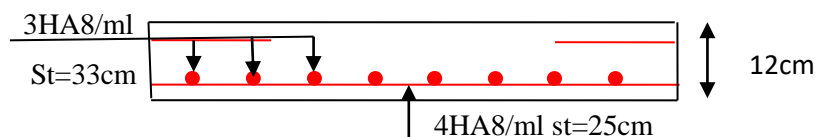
Schéma de ferrailage de la dalle pleine (D1)
